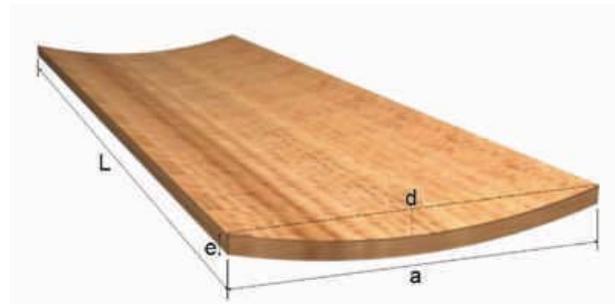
62: Alabeo o deformación de la madera llamado acanaladura.
